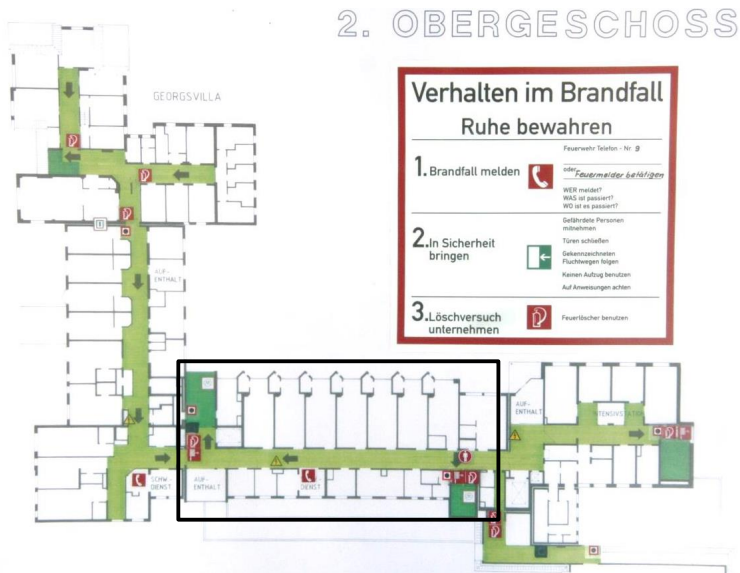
Grundriss und Fluchtplan Krankenhaus Bad Pyrmont, 2.OG mit Markierung des aufgenommenen Bereichs (Quelle: Volk, KIT/IIP)
